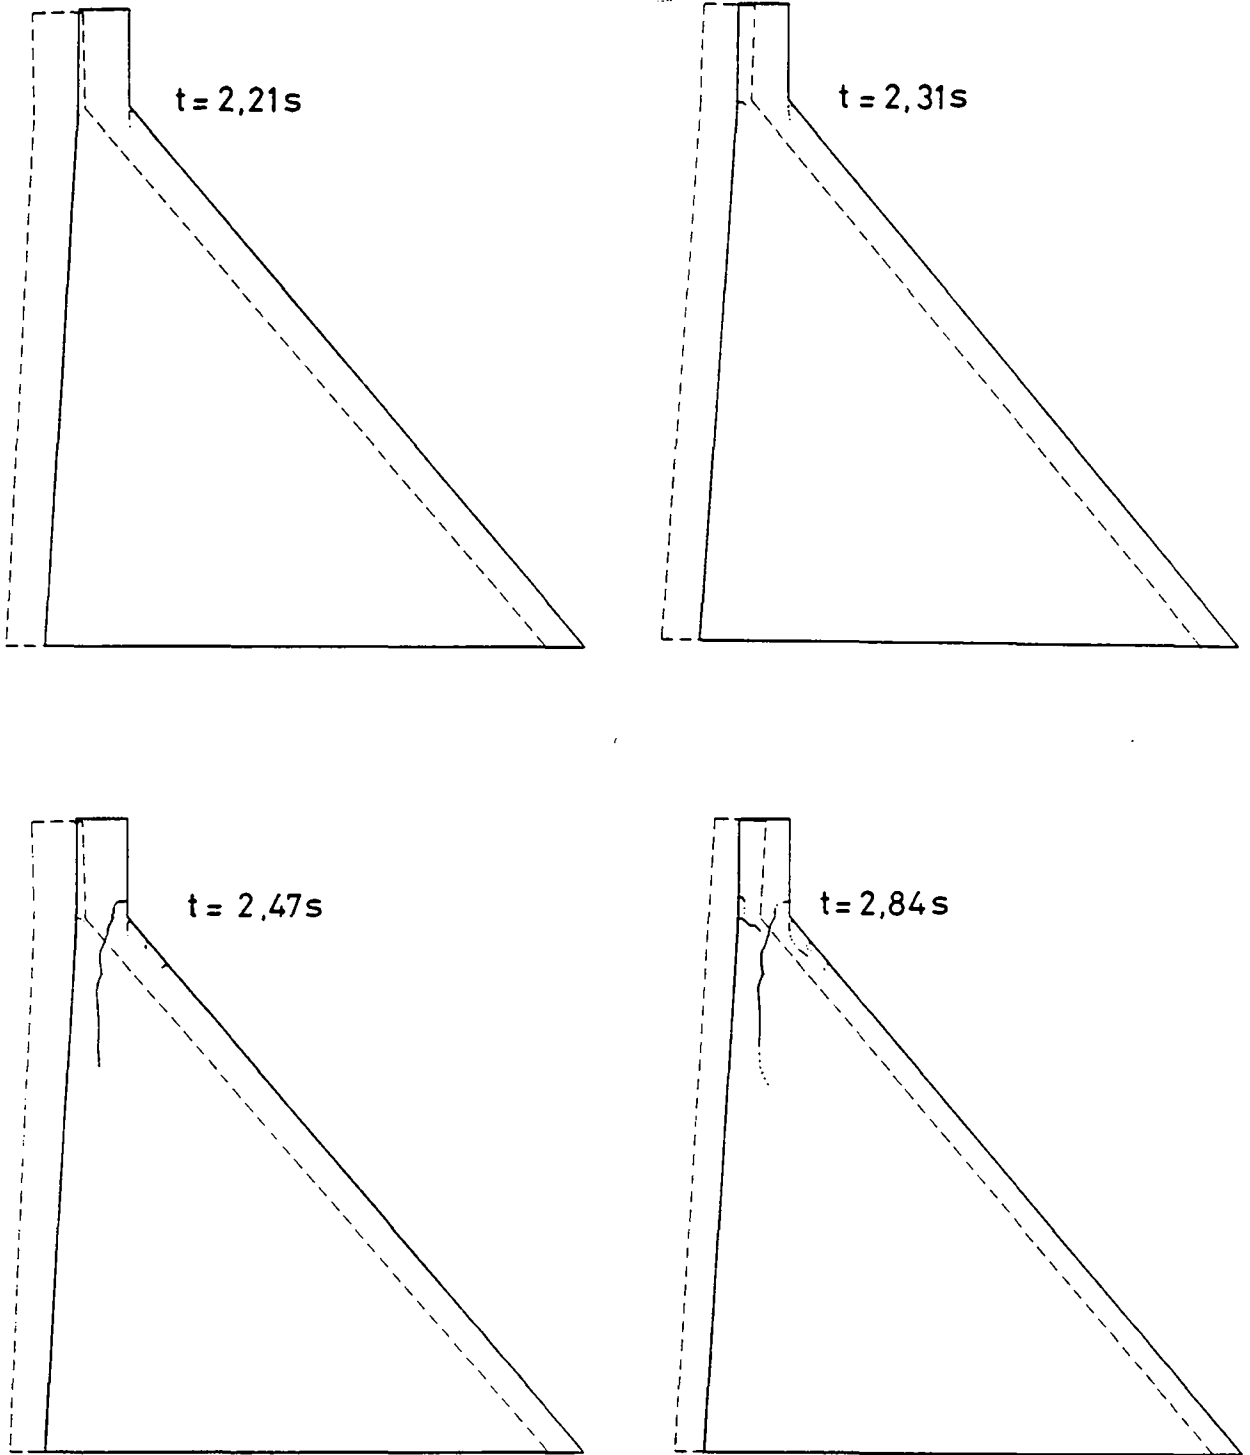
déformée et fissuration du barrage
